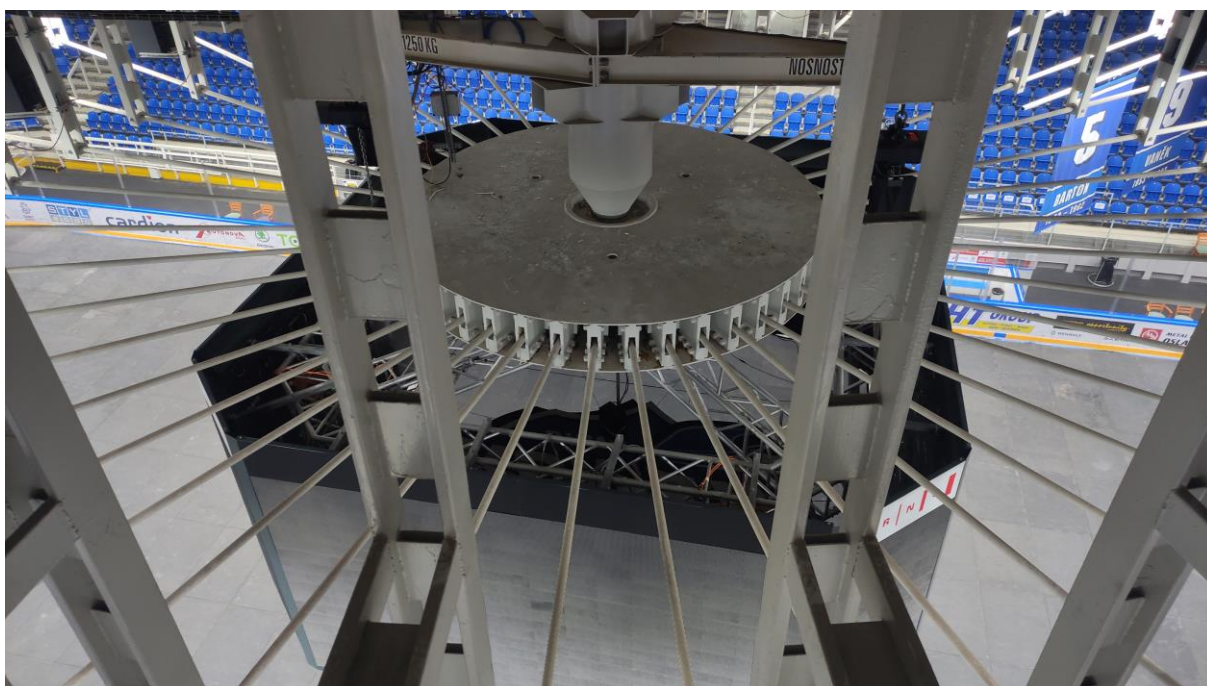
Detailní pohled na rozpínací vřeteno a kotevní prstence dolních lan
